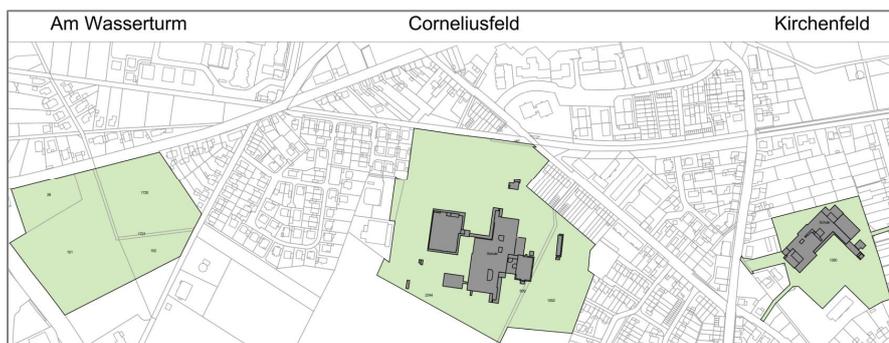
Lageplan Bestandssituation (Quelle: Stadt Tönisvorst und assmann GmbH)
